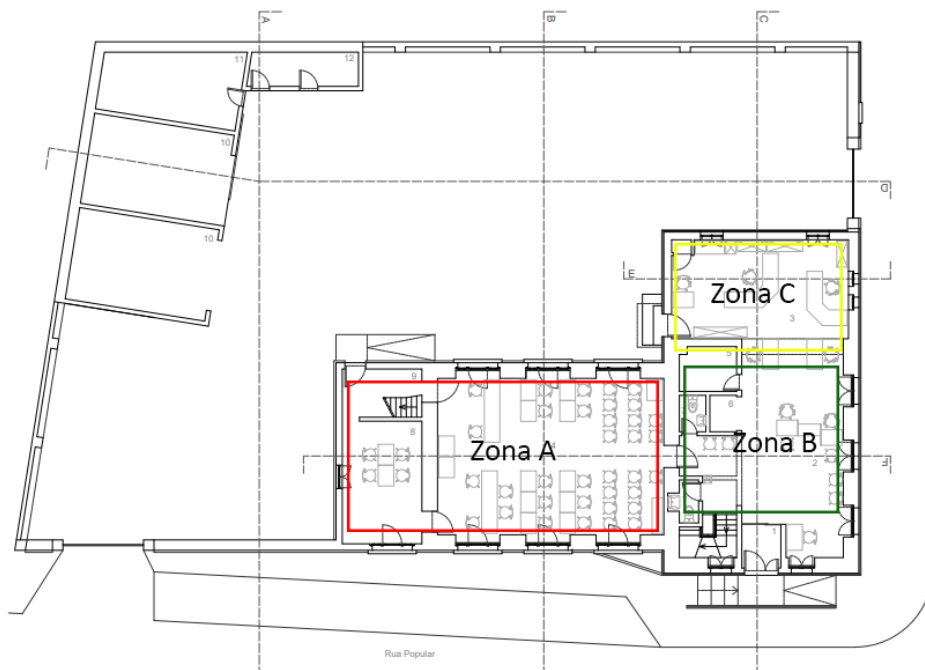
Planta Piso 0- Indicação Zonas Espaço
